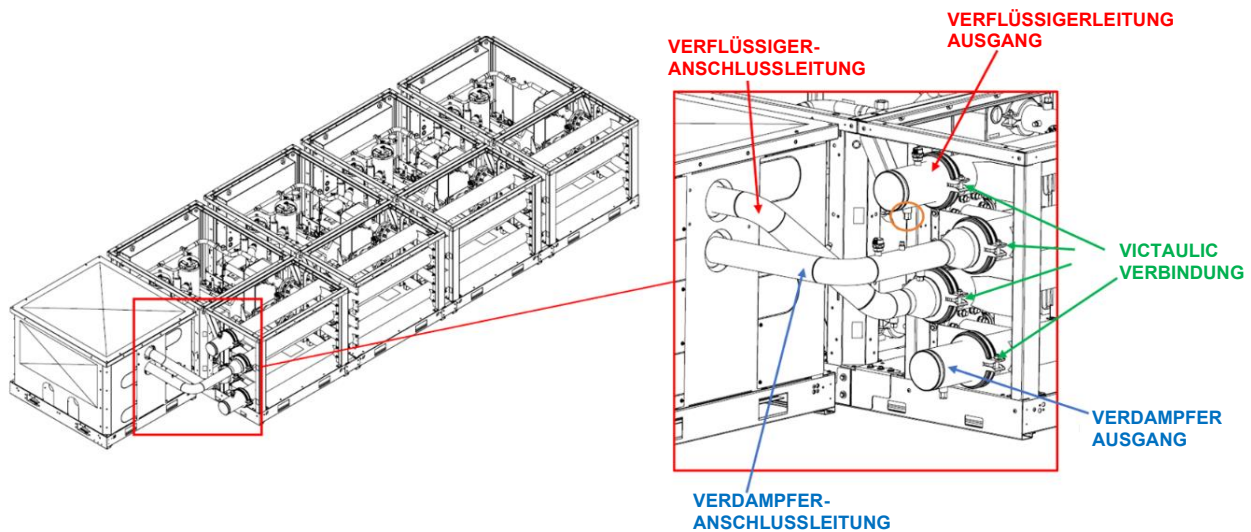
Installation des Pumpenmoduls - Details zur Verrohrung
